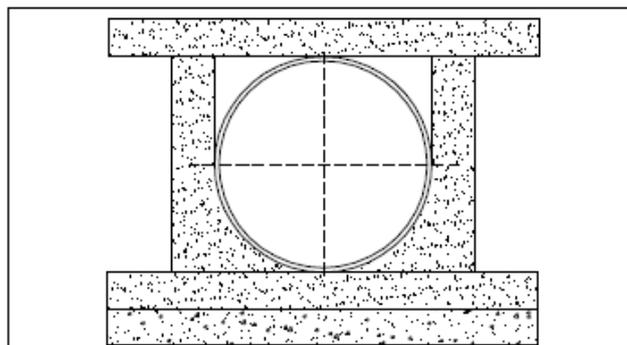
Representação de um TL em uma planta de cálculo ou execução.
